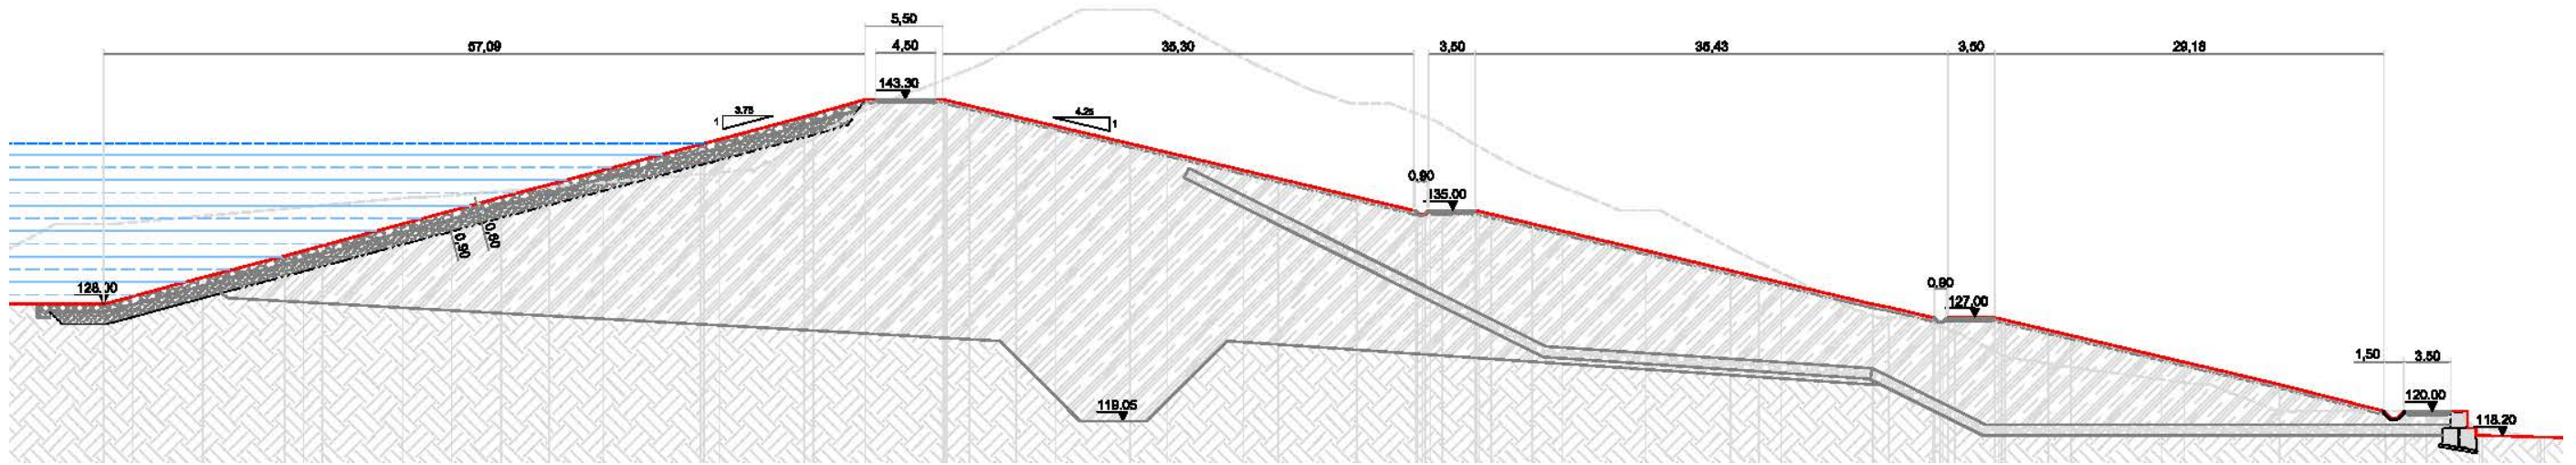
Sezione principale del corpo diga (sezione CR_08).
